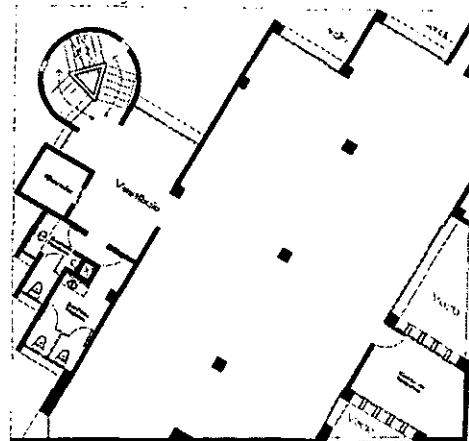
y 167 Edificio de oficinas, plantas arquitectónicas (AOV).
